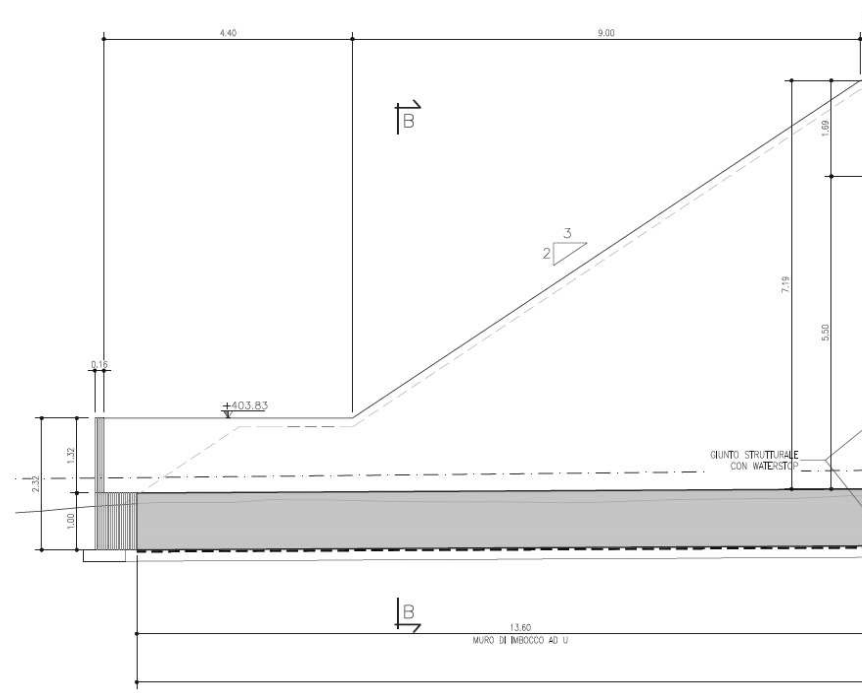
Muri di sbocco - Sezione longitudinale
